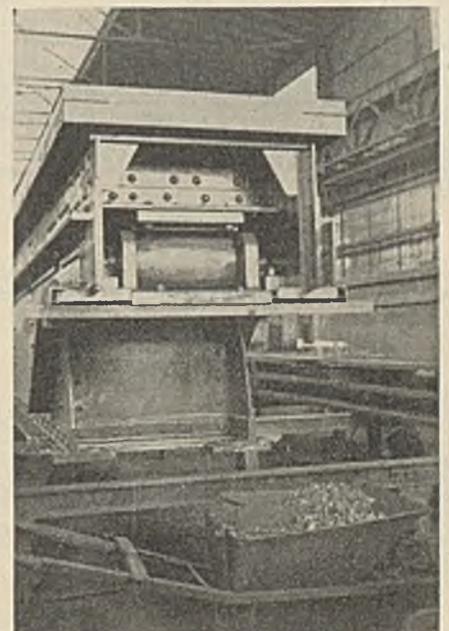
Lager des Hauptlängsträgers in der Werkstatt.
